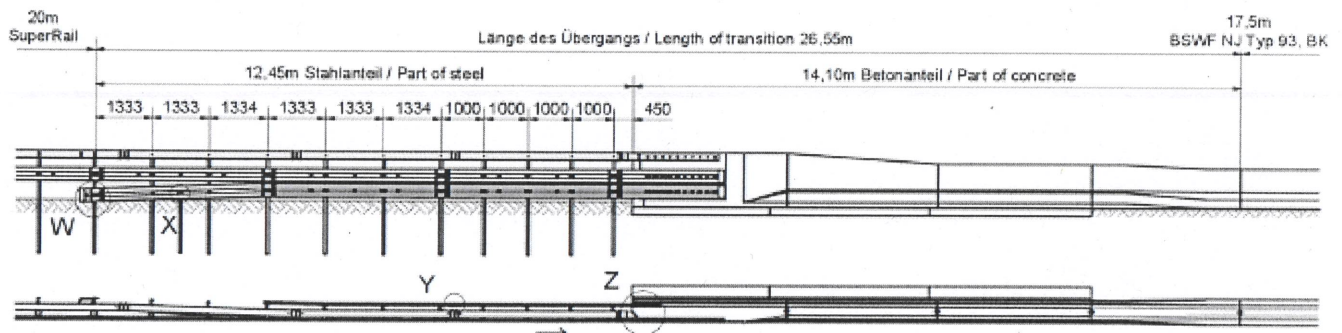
Aufbau der Übergangskonstruktion BeStConnect SR-NJ 93BK
